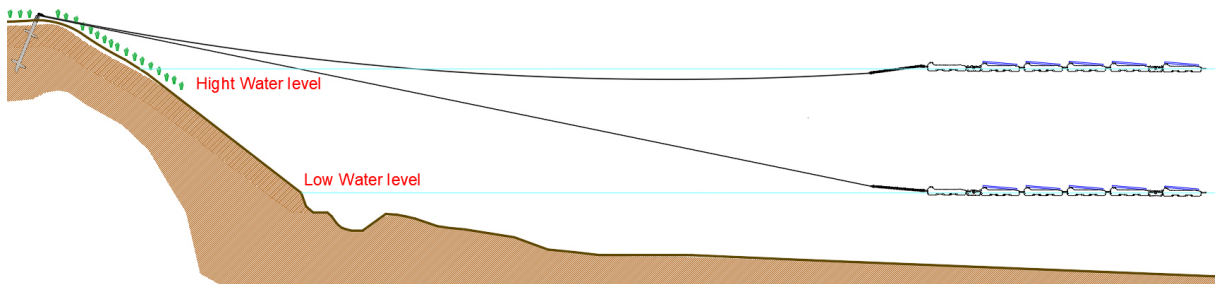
Exemple d'un ancrage en berge à niveau d'eau haut et bas
